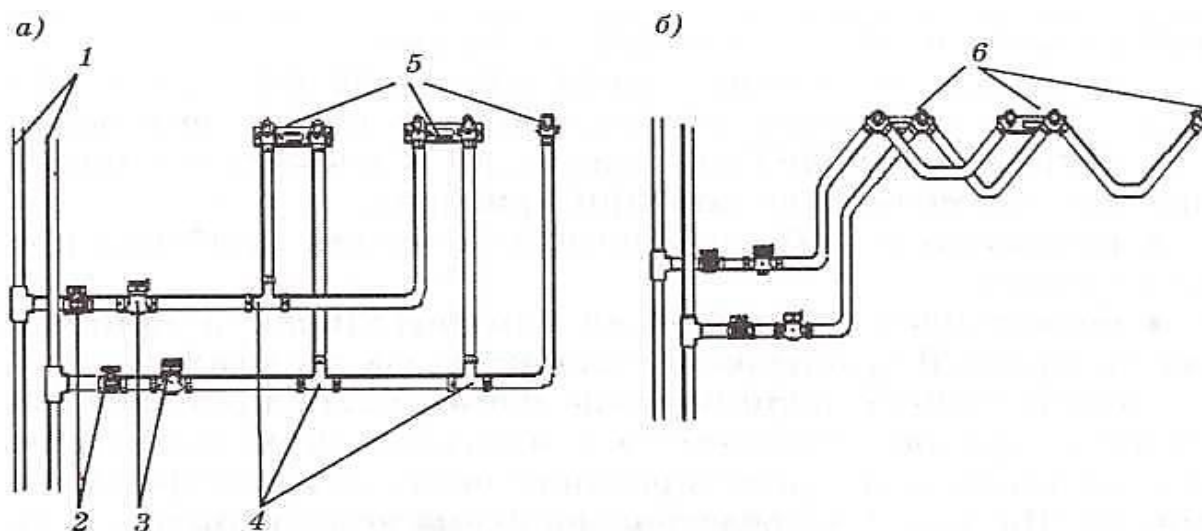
Квартирная разводка через тройники (а) и с проходными водорозетками (б): 1 – стояки холодного и горячего водопровода; 2 – вентиль или шаровой кран; 3 – водосчетчик; 4 – тройники; 5 – места подключения водоразборной арматуры; 6 – водорозетки проходные
